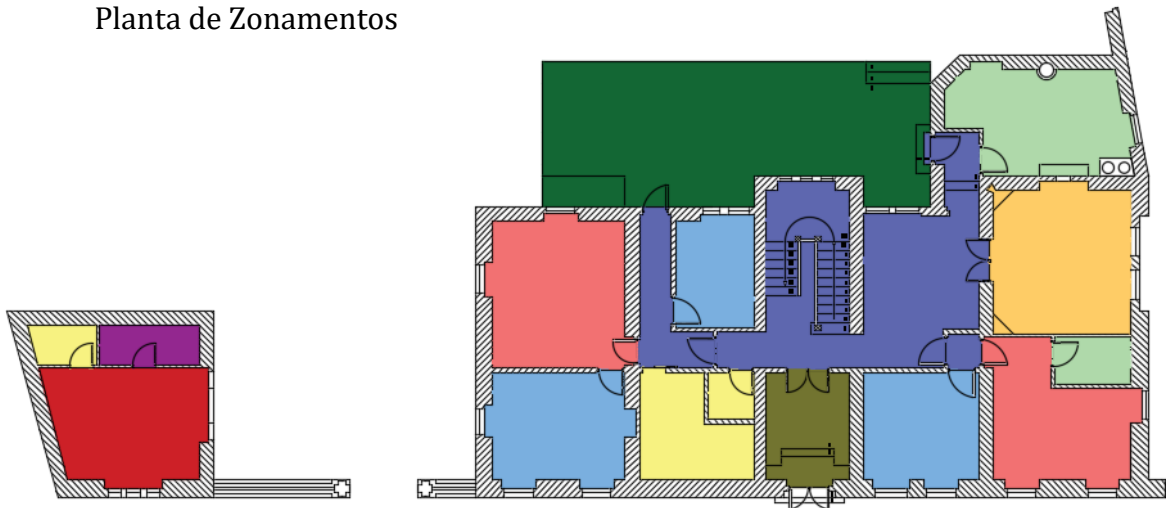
Planta de Zonamentos, Piso Rés-do-Chão
